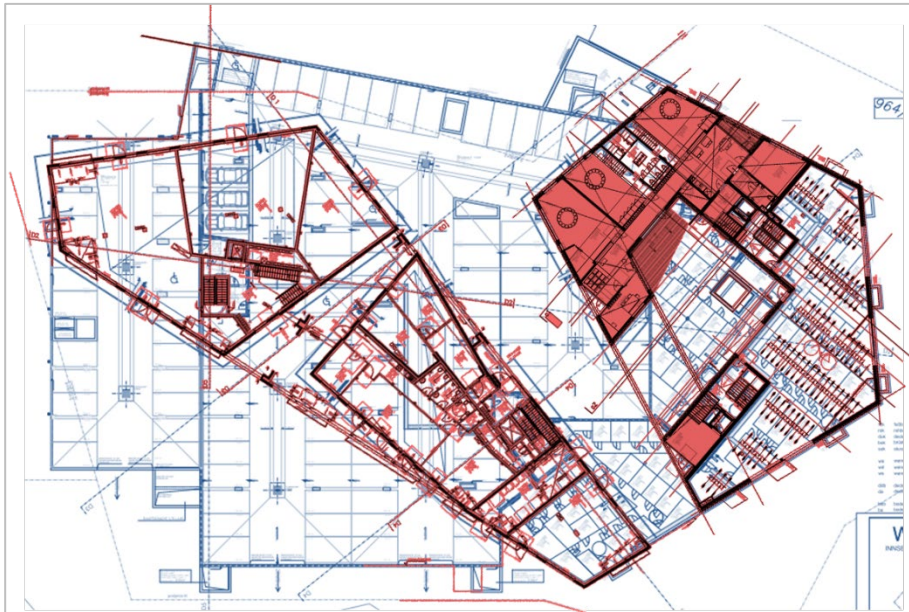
Lage der oberirdischen Geschosse (rot) auf den darunterliegenden Tiefgaragen- und Kellergeschoßen (blau) am Beispiel von Haus C & D (© NHT)
